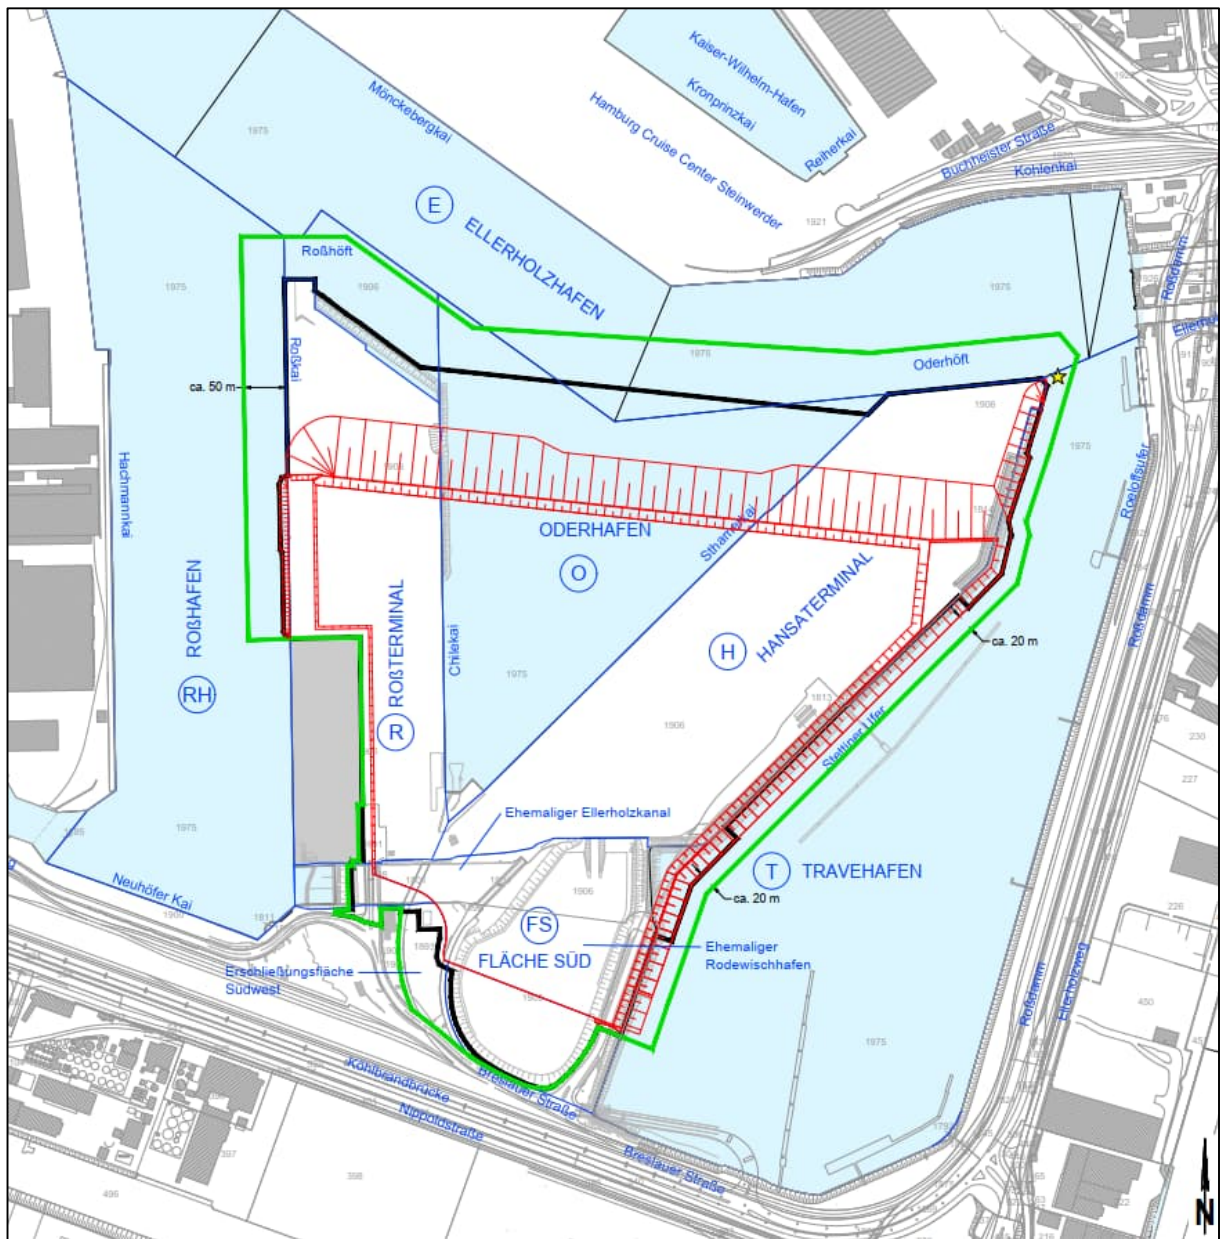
Vorhabenfläche (grün umrandet) mit Teilgebieten, Rück- und Einbaufläche (schwarz umrandet) und geplante Nutzfläche mit Böschungen (orange) (Teil I des Antrages auf Planfeststellung)
